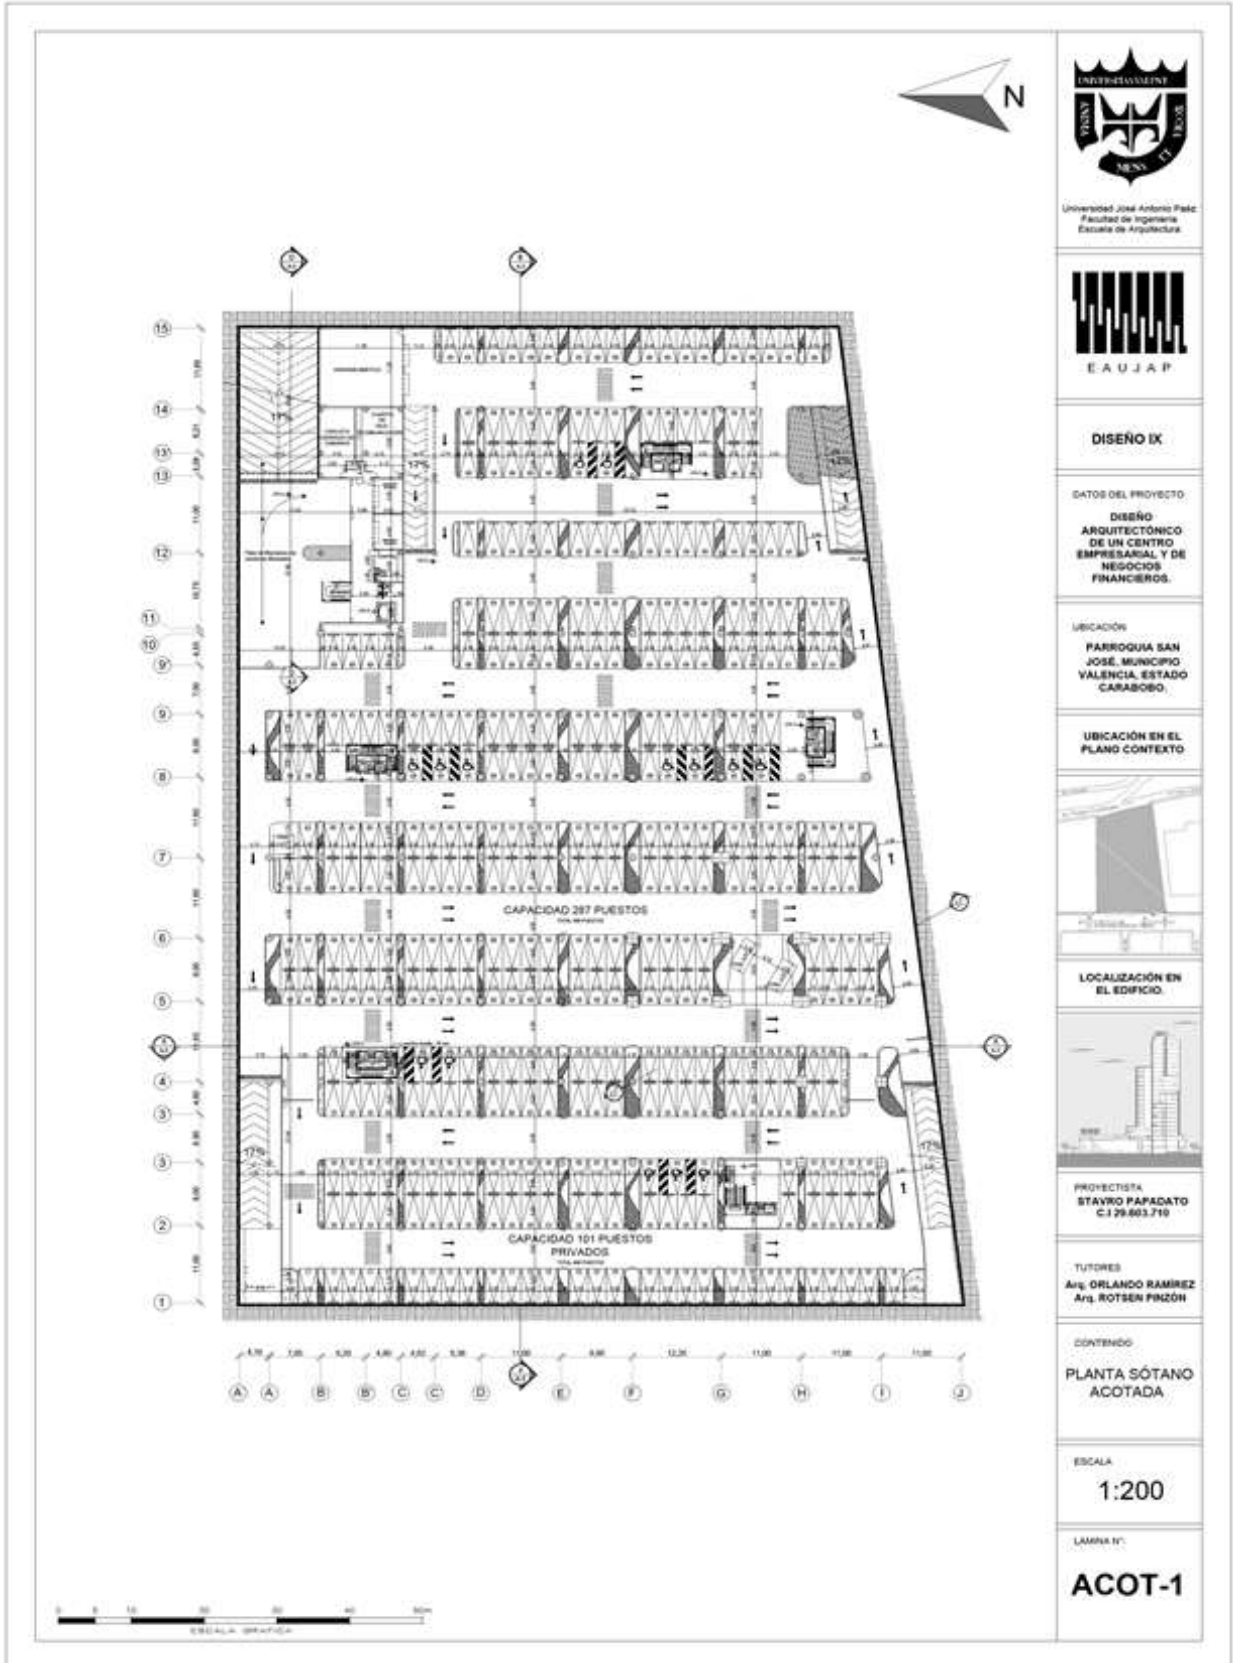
ACOT – 1 Plano Sótano Acotada Fuente: El Autor (2023)
